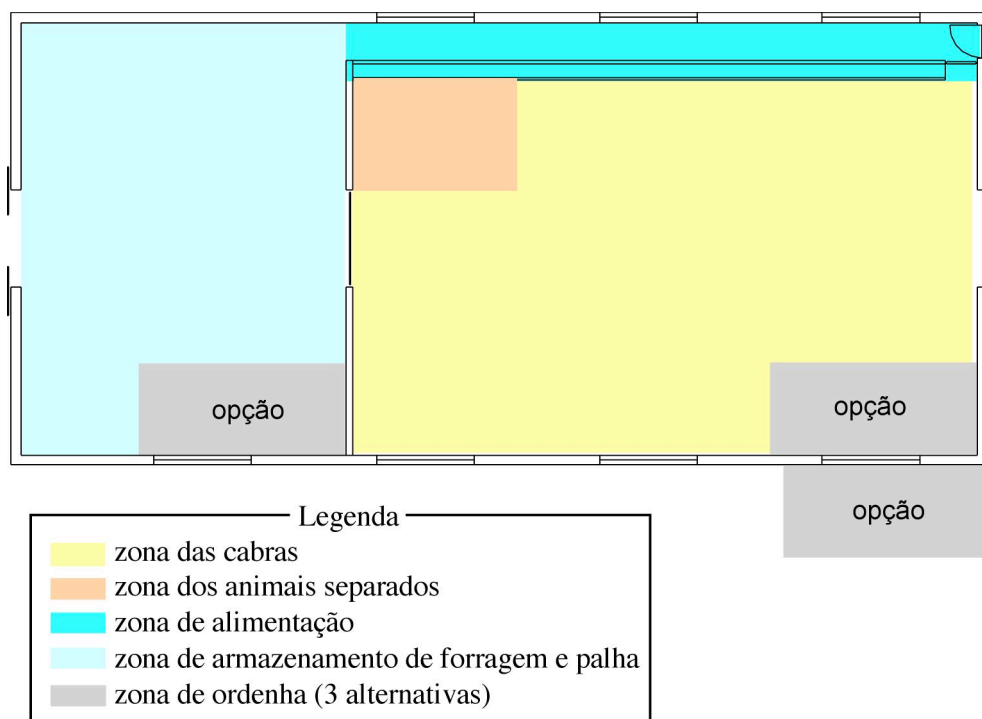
Proposta de distribuição em planta para alojamento de caprinos. Modelo 1.
